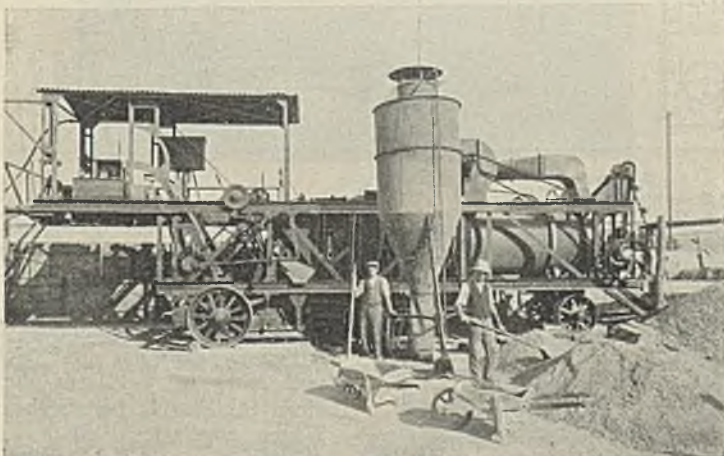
Straßenbaumaschine für 12 t Stundenleistung auf der Baustelle.
